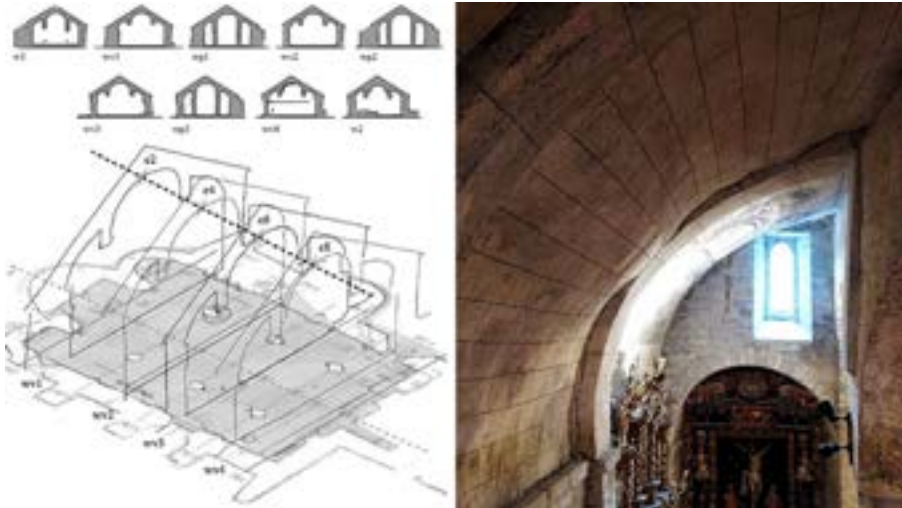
Detall des seccions transversaus de Santa Maria d'Arties [34]
